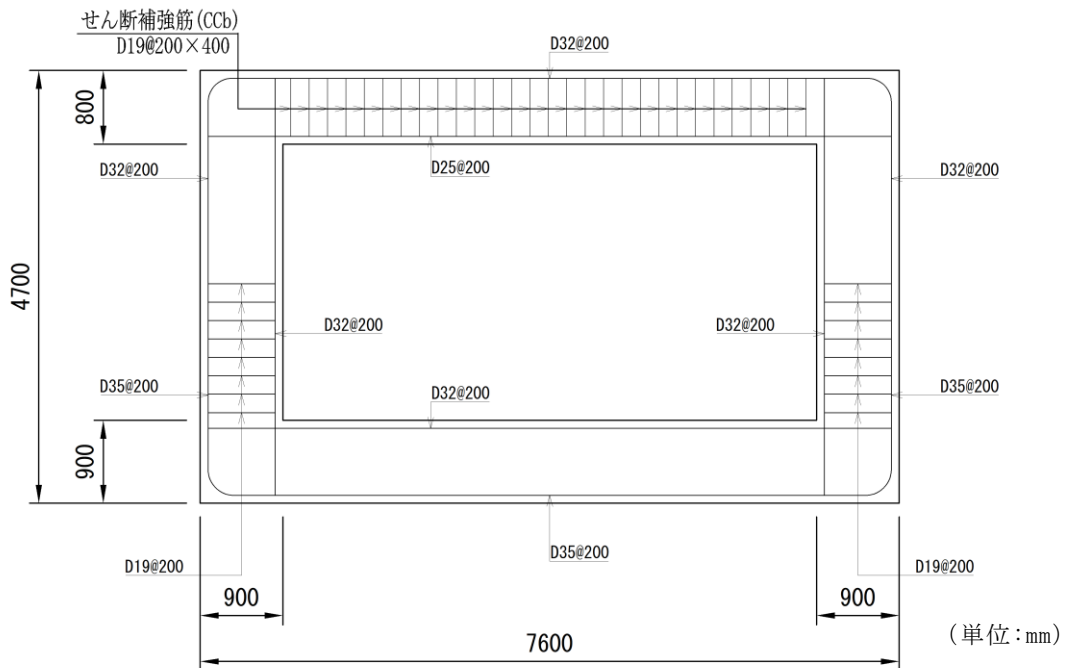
屋外配管ダクト (タービン建物～放水槽) 概略配筋図 (C-C 断面)
